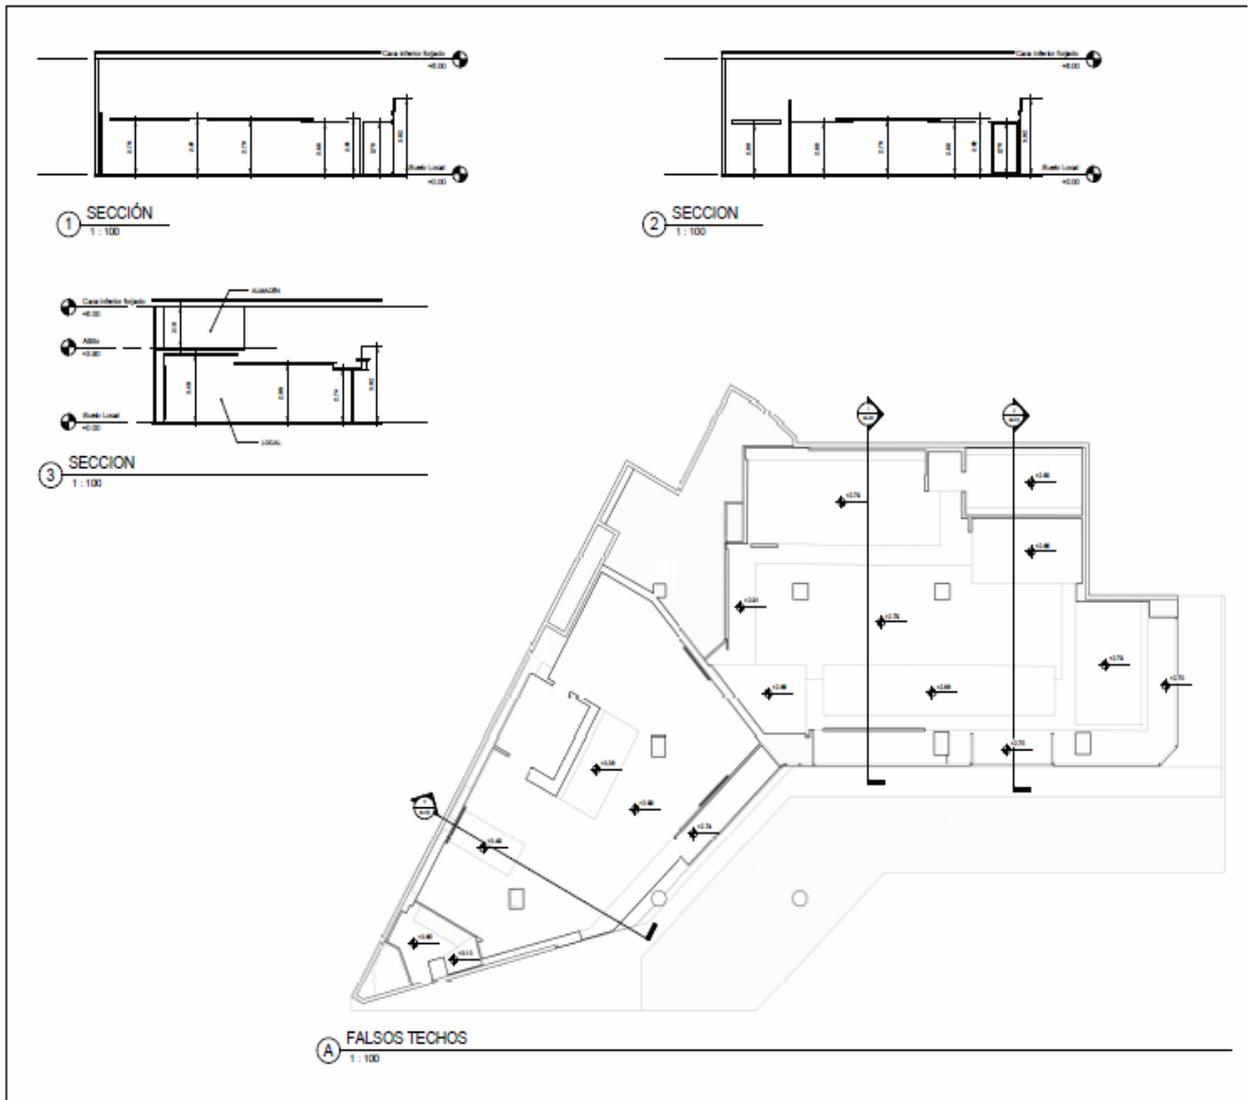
Plantas resultantes de secciones y alzados de levantamiento tradicional. (fuente: propia)
